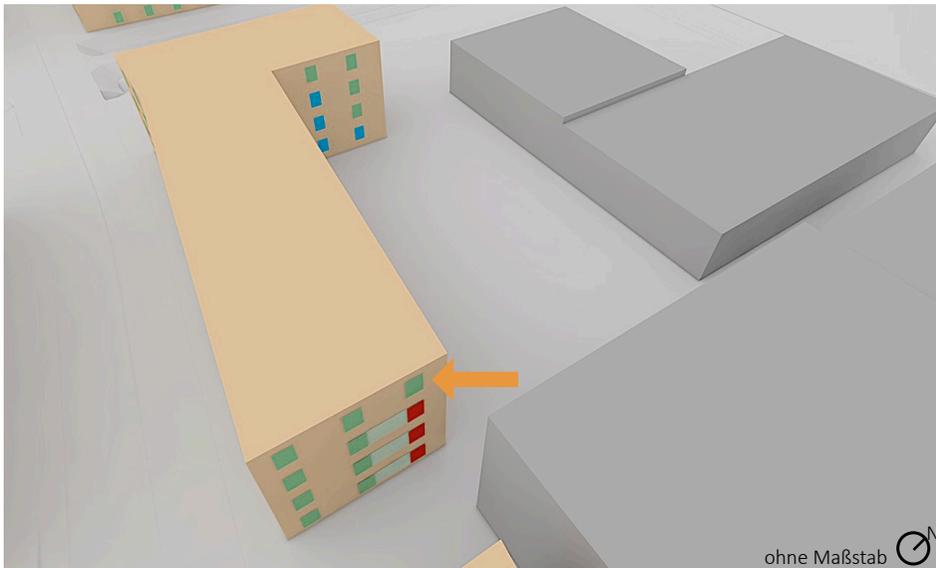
Maßnahme - QN-BF 3 Ostfassade - Gebäudestand 26.01.2024
